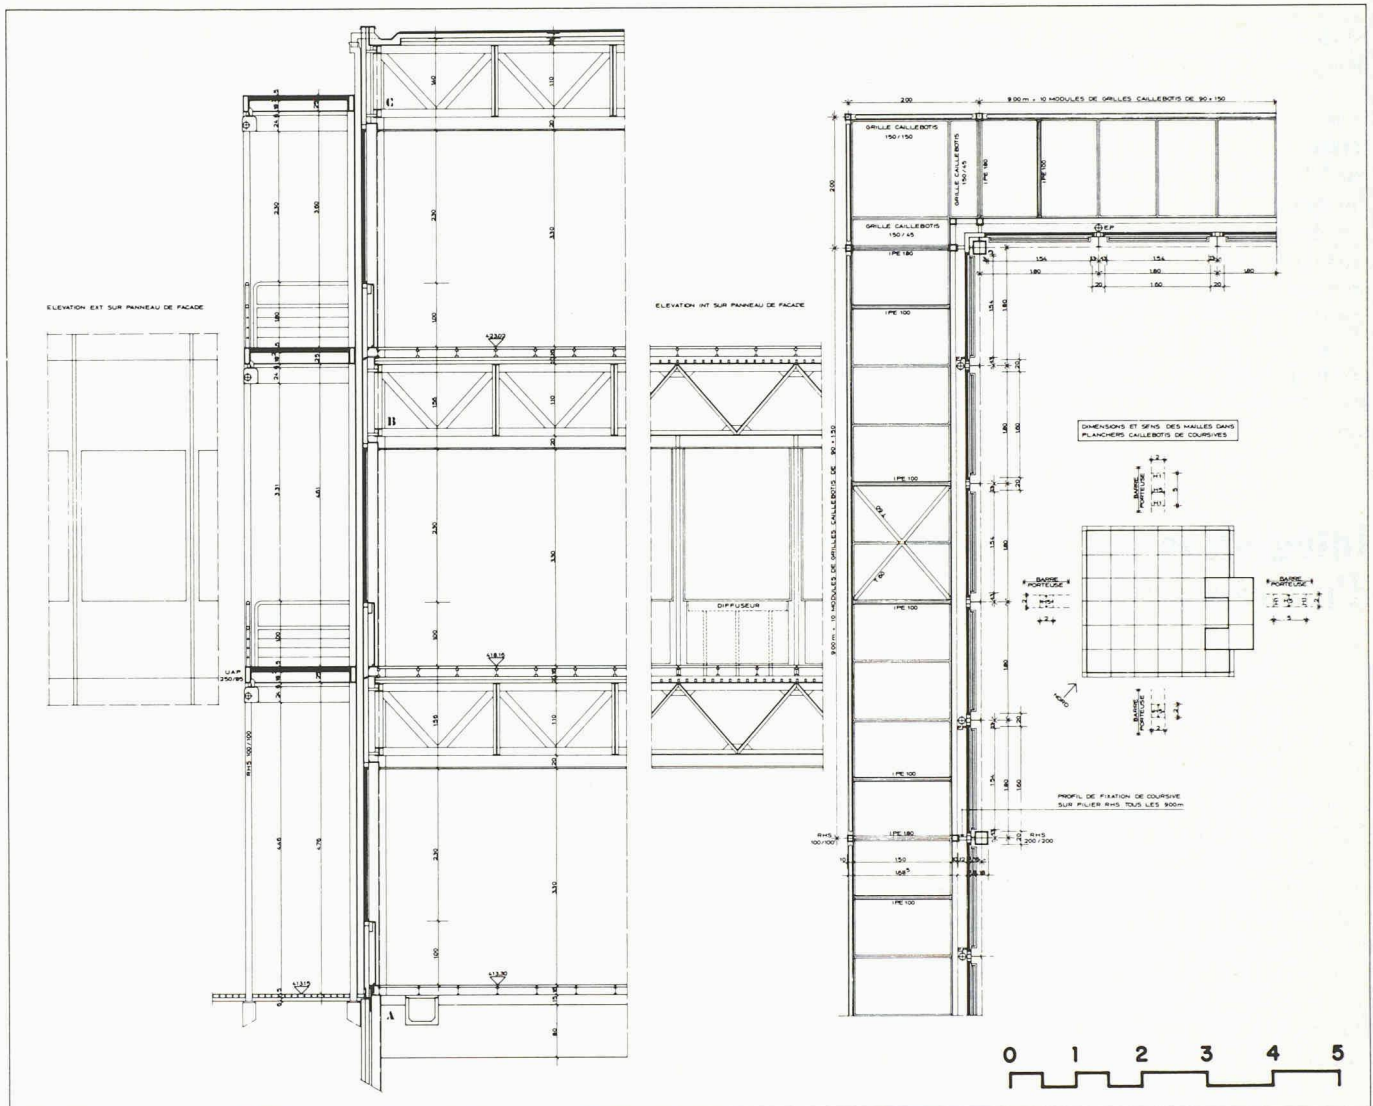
Détails de construction de la façade, montrant notamment les dispositions prises en fonction de l'équipement du bâtiment.
